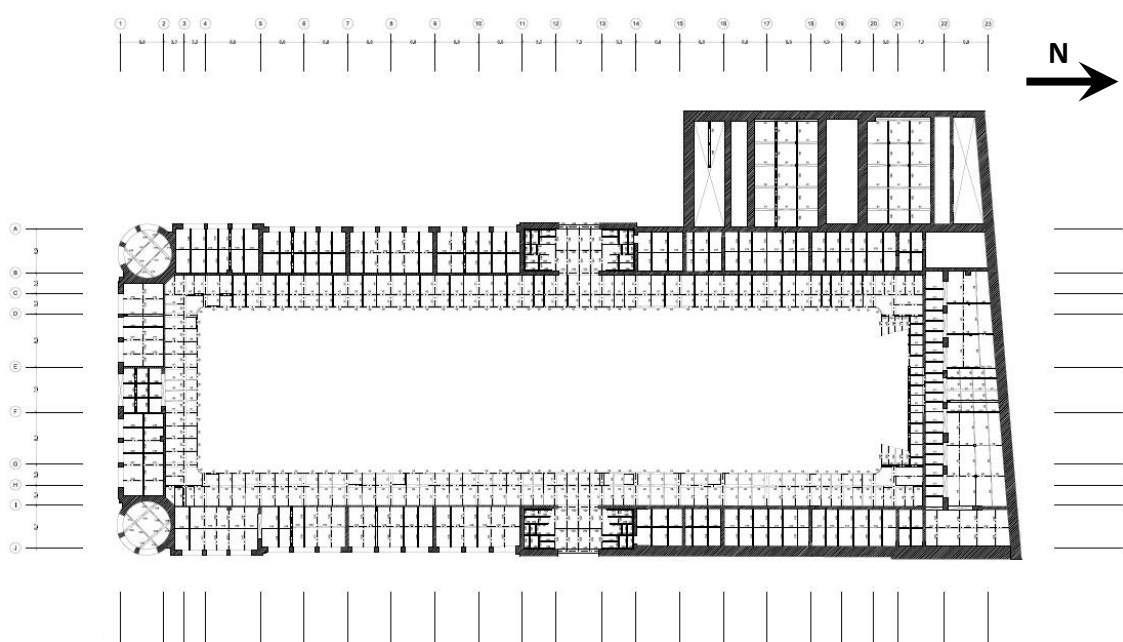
Planta estrutural do nível 1 do Mercado do Bolhão.
